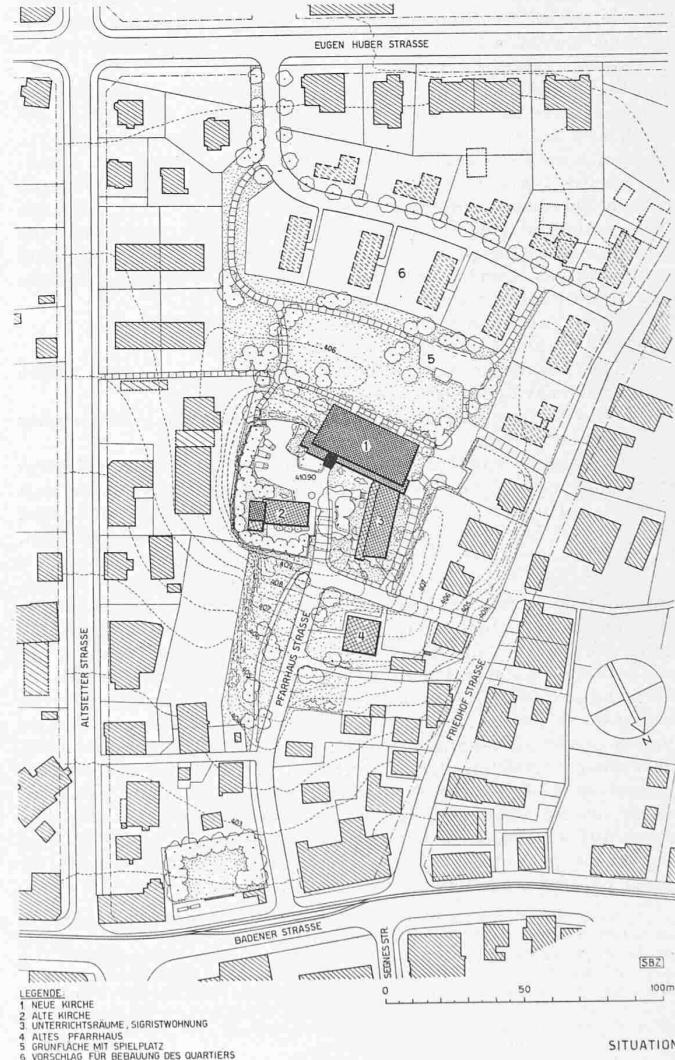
Lageplan des Kirchenhügels Zürich-Altstetten. — Masstab 1:2500
